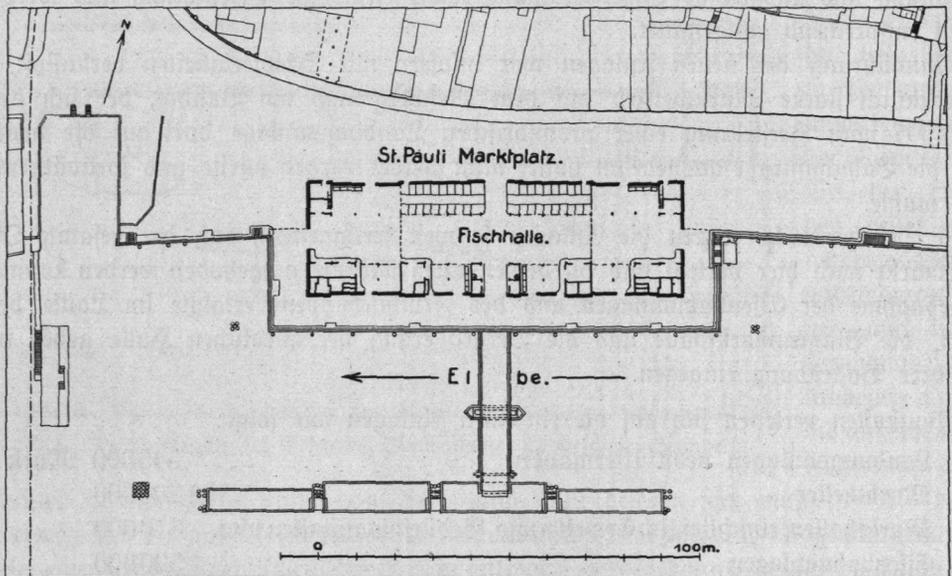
St.-Pauli-Fischmarkt, Lageplan und Hallengrundriß.
